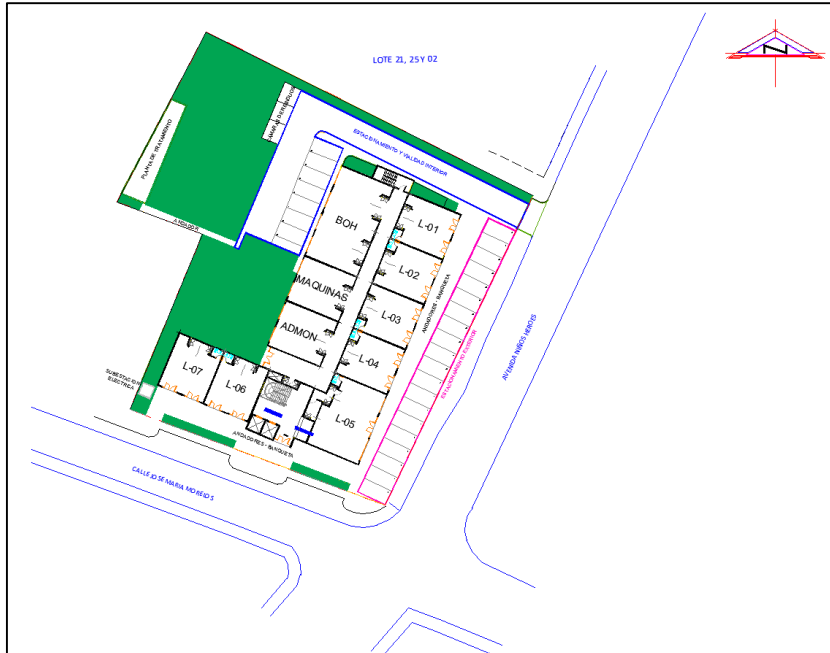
Áreas que conformarán la planta baja del hotel del puerto.
